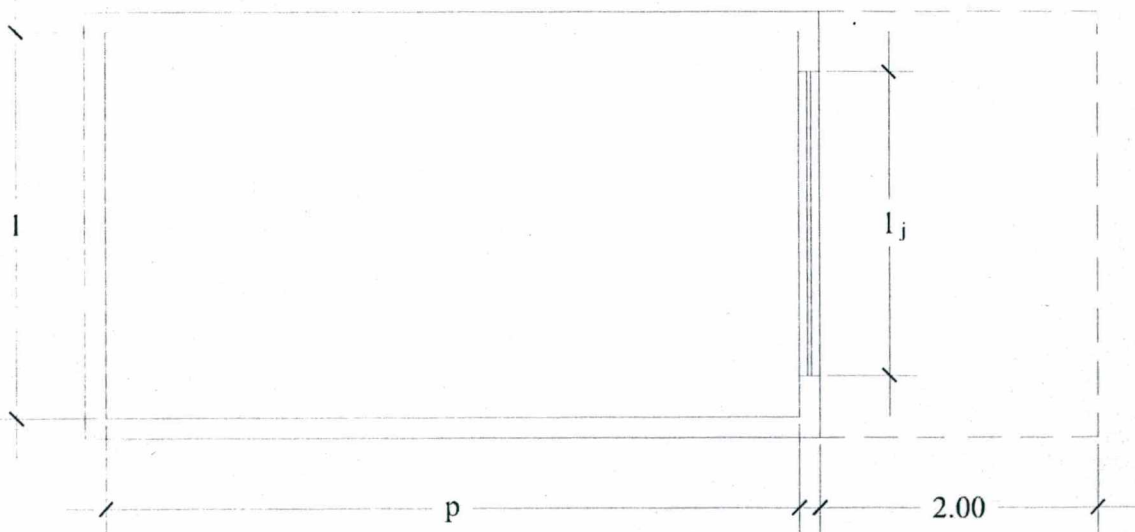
Planta baixa esquemática dos modelos de estudo para simulação.
